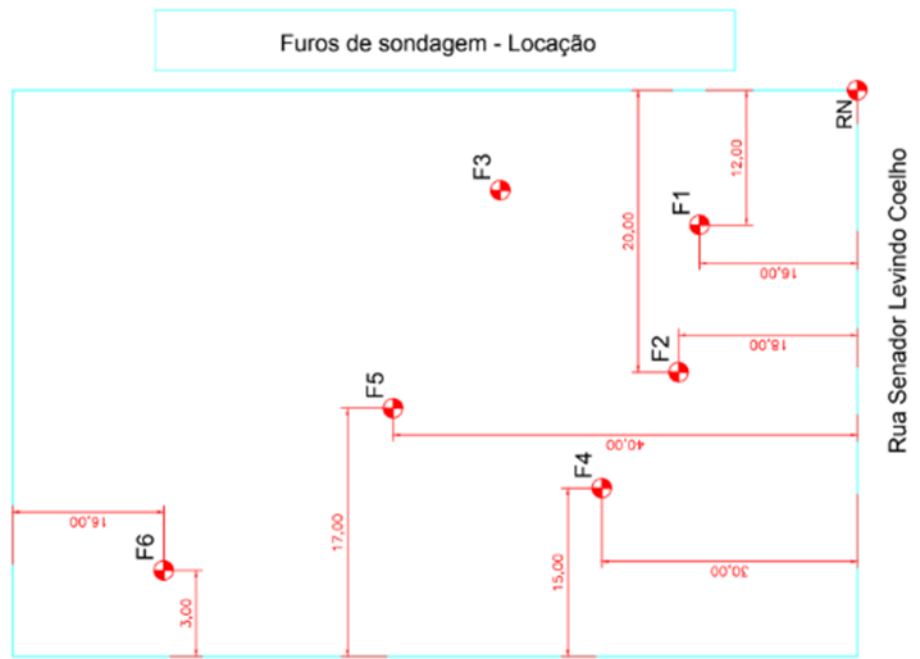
Furos de sondagem ao longo do terreno. (Fonte: Empreendedor, 2025)
